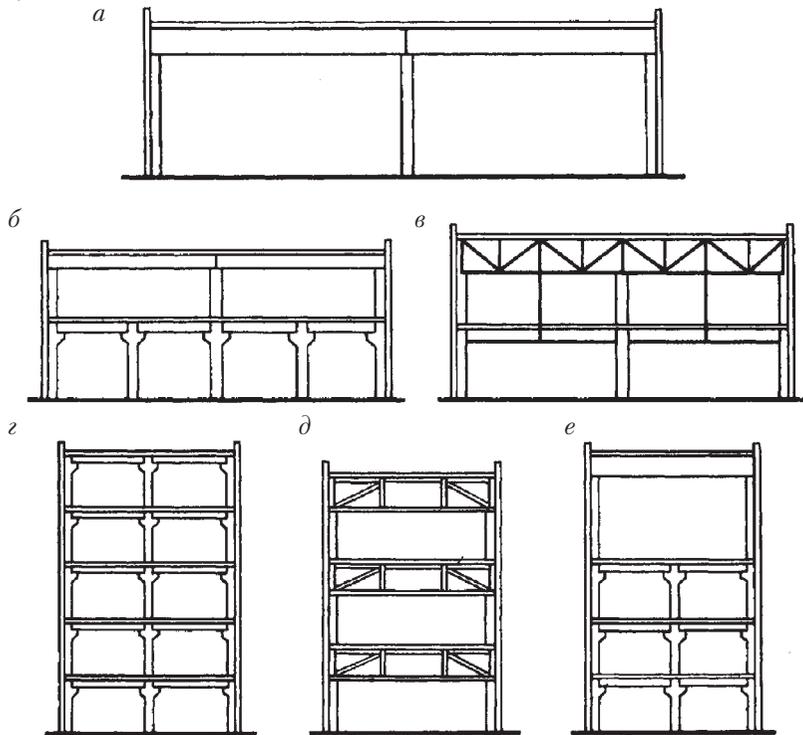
Производственные здания различной этажности: *а* – одноэтажное здание; *б* – двухэтажное здание с укрупненной сеткой колонн верхнего этажа; *в* – двухэтажное здание с подвеской перекрытия к усиленной стропильной конструкции; *г* – многоэтажное здание с постоянной сеткой колонн на всех этажах; *д* – многоэтажное здание с техническими этажами; *е* – многоэтажное здание с укрупненной сеткой колонн верхнего этажа
